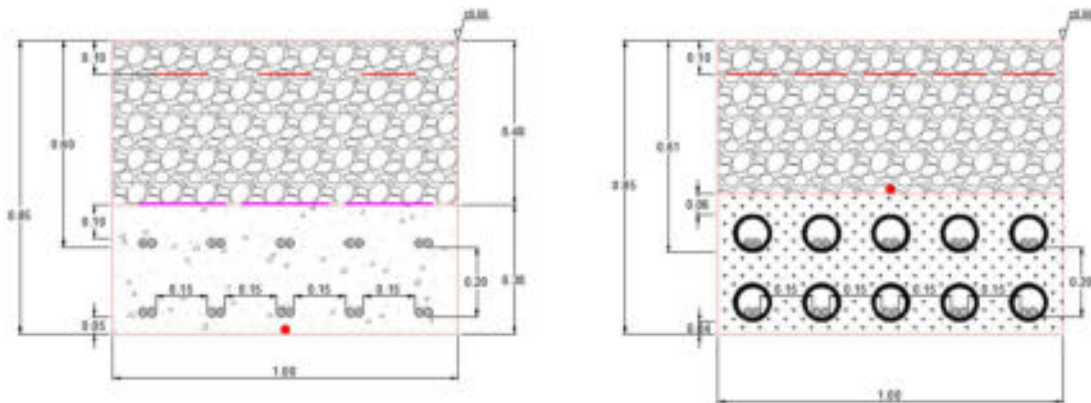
Detalle de zanjas BT normal y reforzada hasta 10 circuitos
